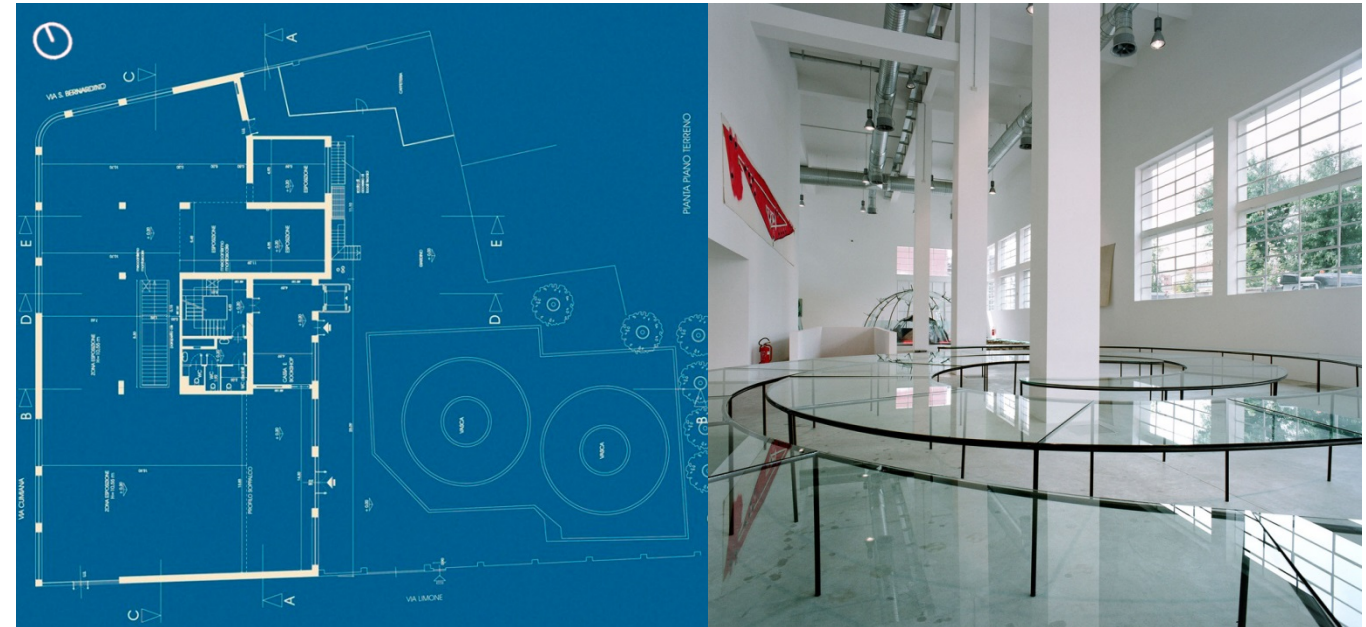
Planta de la intervención (izq.) y fotografía del interior (der.).
